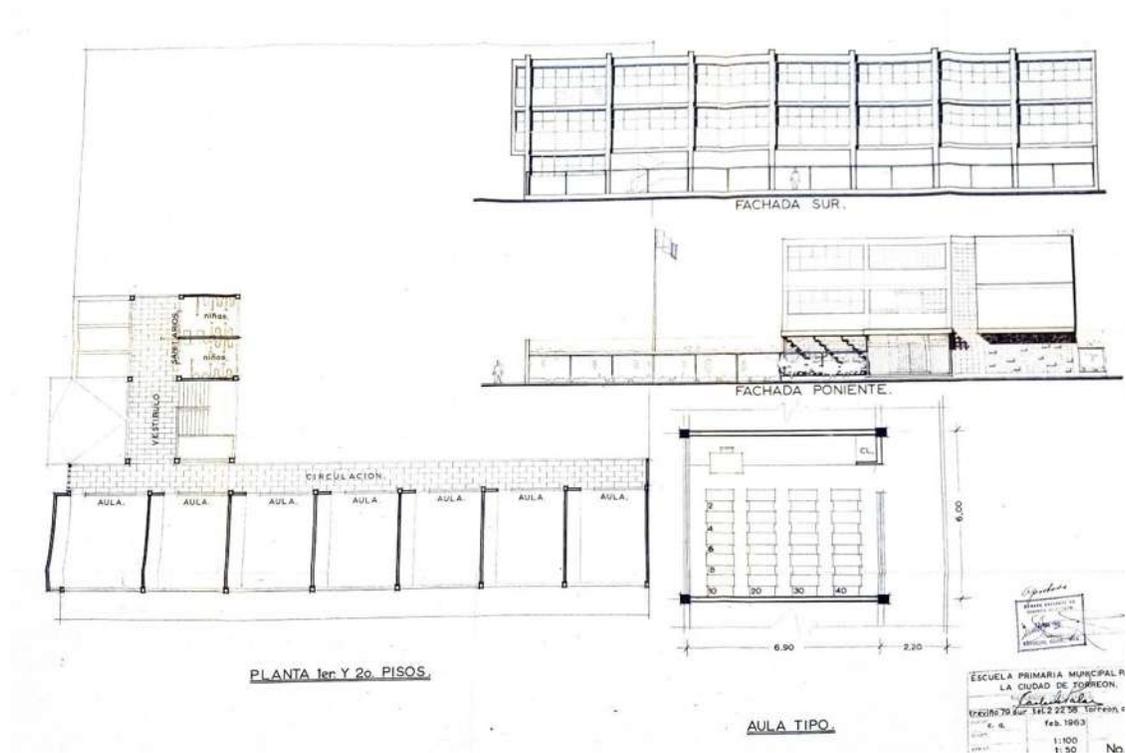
Planimetría 2 escuela Eva Sámano de López Mateos.
